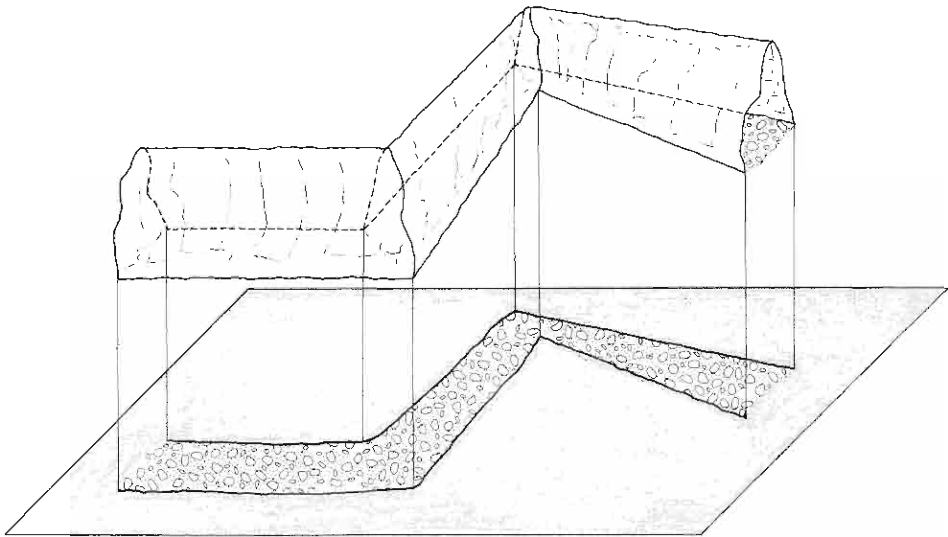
,1 - Parte di galleria nella sua proiezione planimetrica
